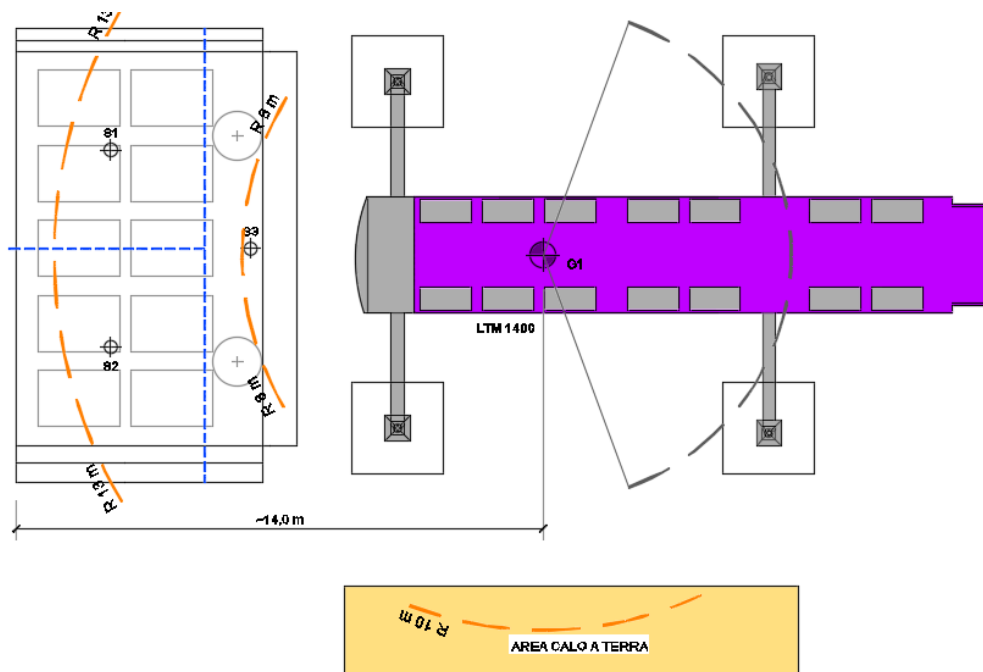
Piazzamento tipo mezzo di sollevamento – Pulvino S1
